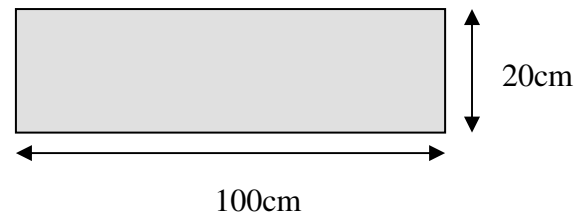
b.2. : Coupe transversal sur voile périphérique
